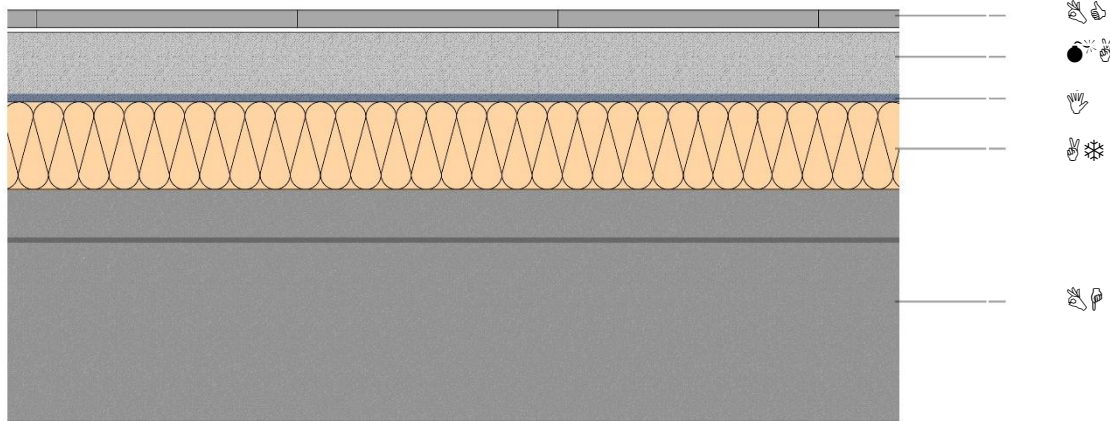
Detalle constructivo suelo. Elaboración propia.
